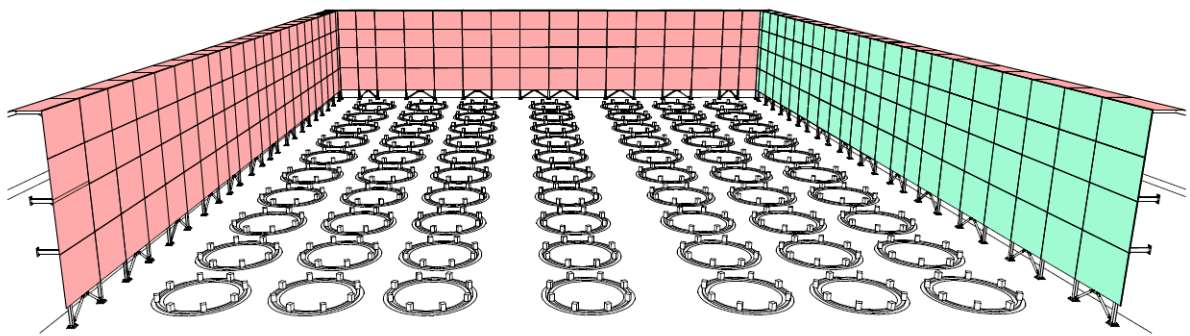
3D-Ansicht der Unterkonstruktion der Stahlverkleidung
